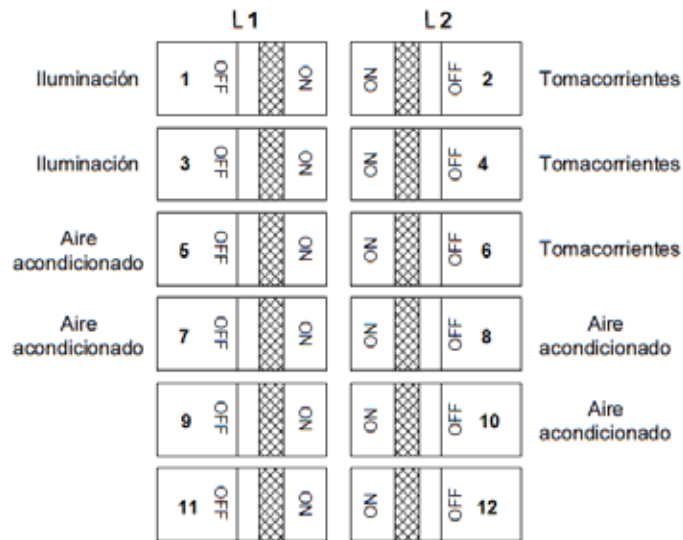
Plano del tablero ubicado en la primera planta de la vivienda
